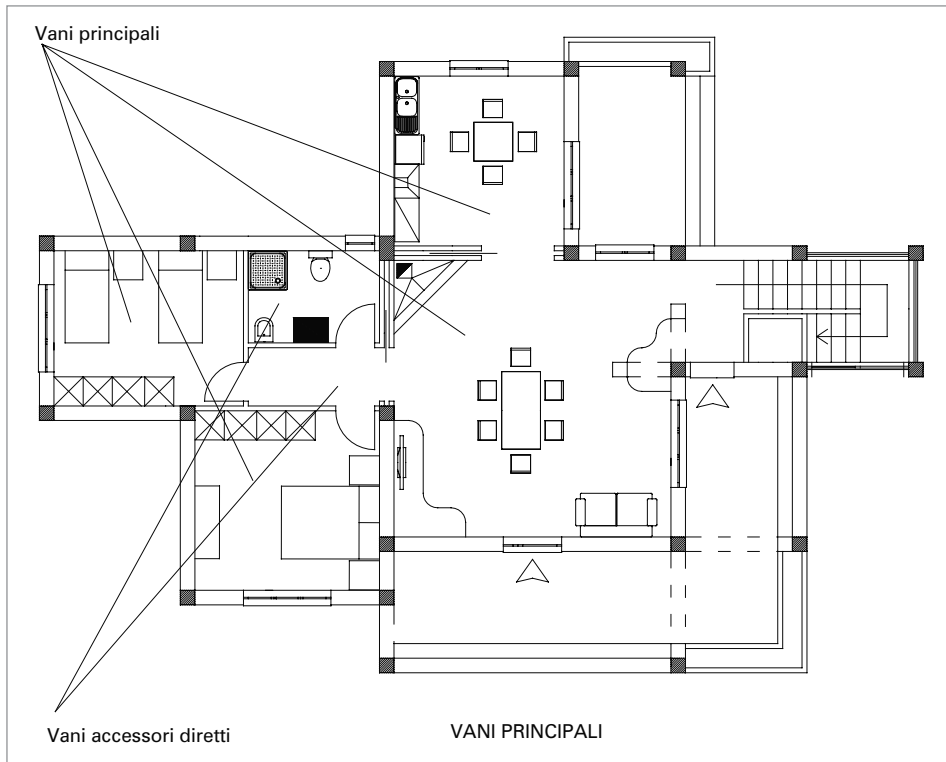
Planimetria di un appartamento con distinzione tra vani principali e vani accessori
